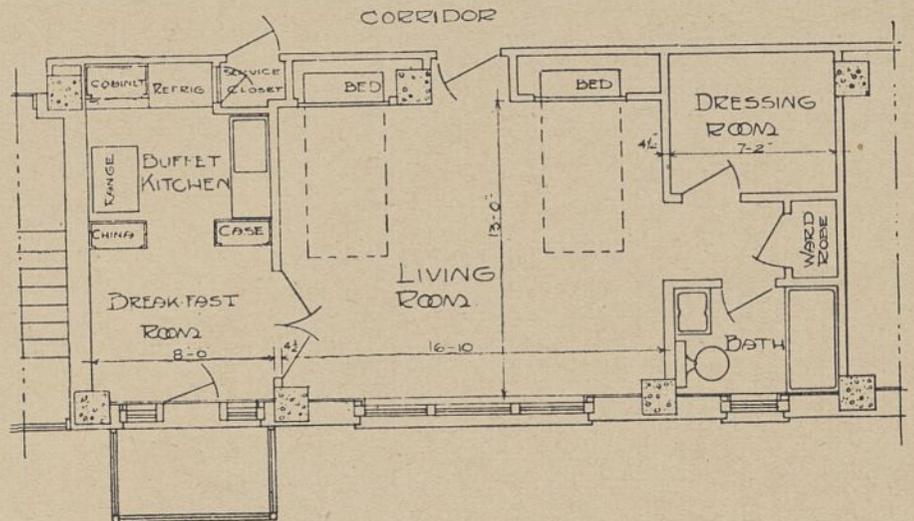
Grundriß einer Wohnung in einem Apartmenthaus.
